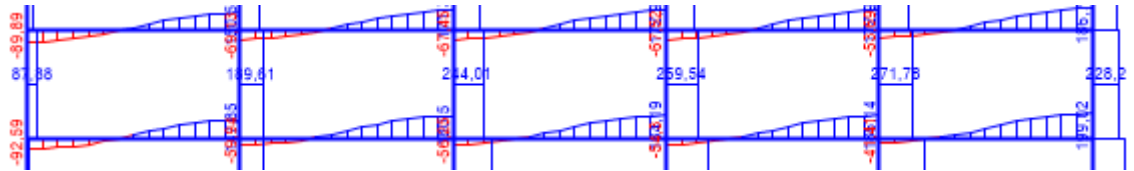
Esfuerzos cortantes en columnas, pórtico C piso 15
